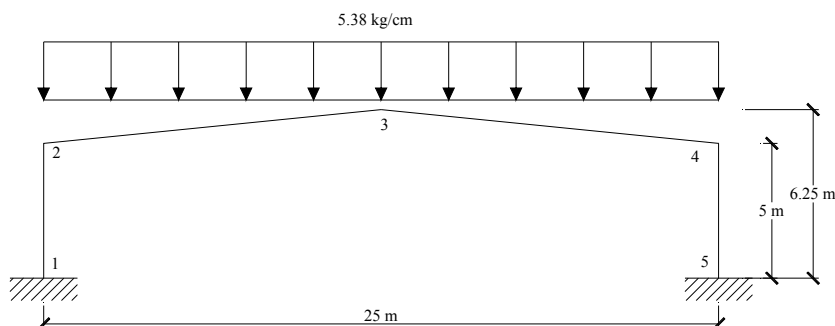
Cargas aplicadas sobre las barras en el pórtico ejemplo.
